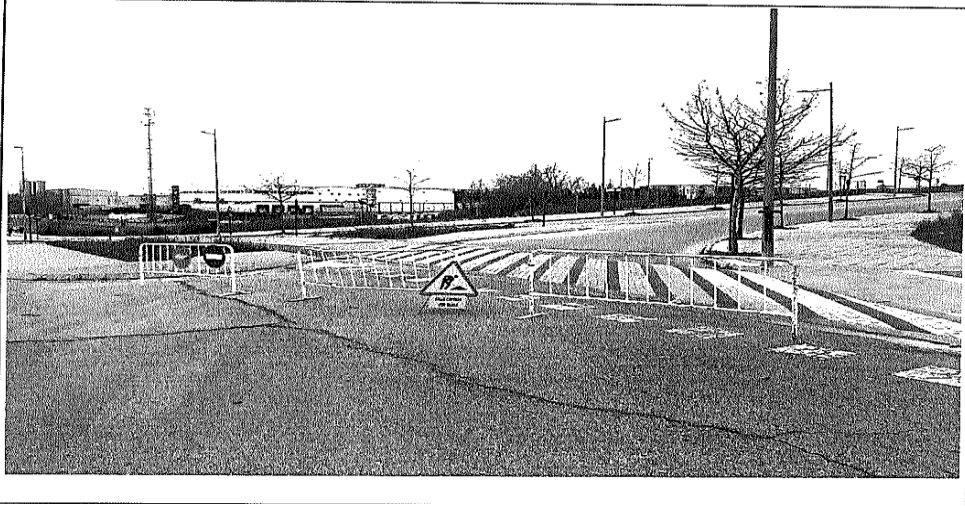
Vista general de la zona de obras y de la señalización.
